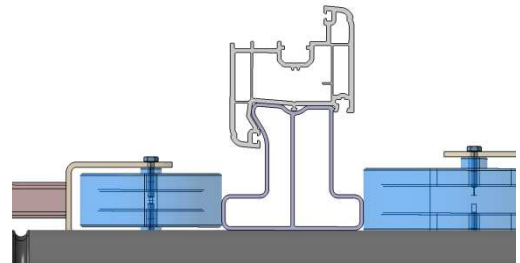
Detalhe de perfil do perfil P3051 + suporte – Pintura das 3 faces.
